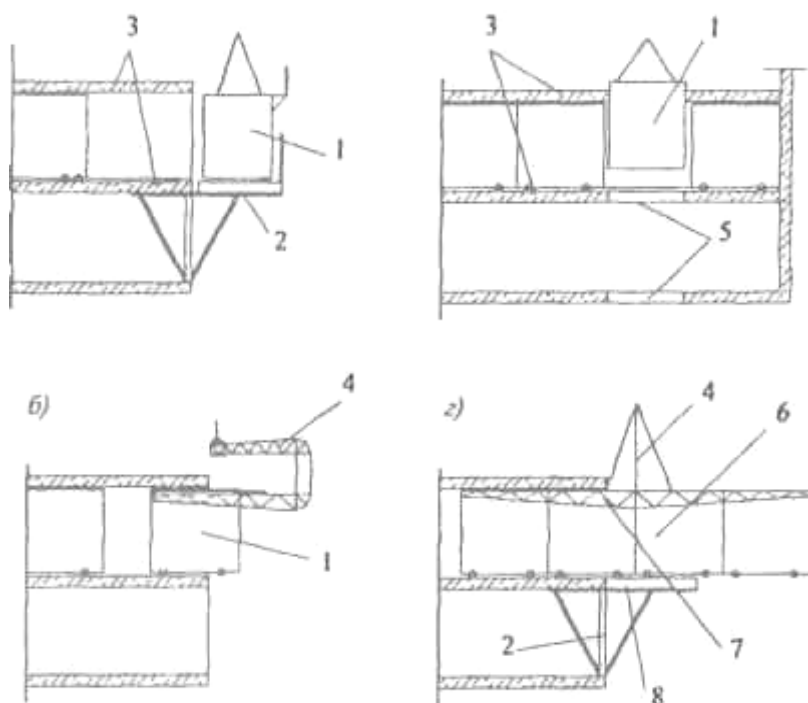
Схема демонтажа объемно-переставной и туннельной опалубки: а - мелкими секциями с помощью выносных подмостей; б — с помощью траверсы «утиный нос»; в — через проемы в перекрытиях; г — крупными блоками с помощью распределительной фермы и подмостей с откидным ограждением; 1 — секция опалубки; 2 — выносные подмости; 3 — перекрытие; 4 — траверса; 5 — проемы в перекрытии; 6 — крупноразмерный блок; 7 — траверса — распределительная ферма; 8 — откидное ограждение
